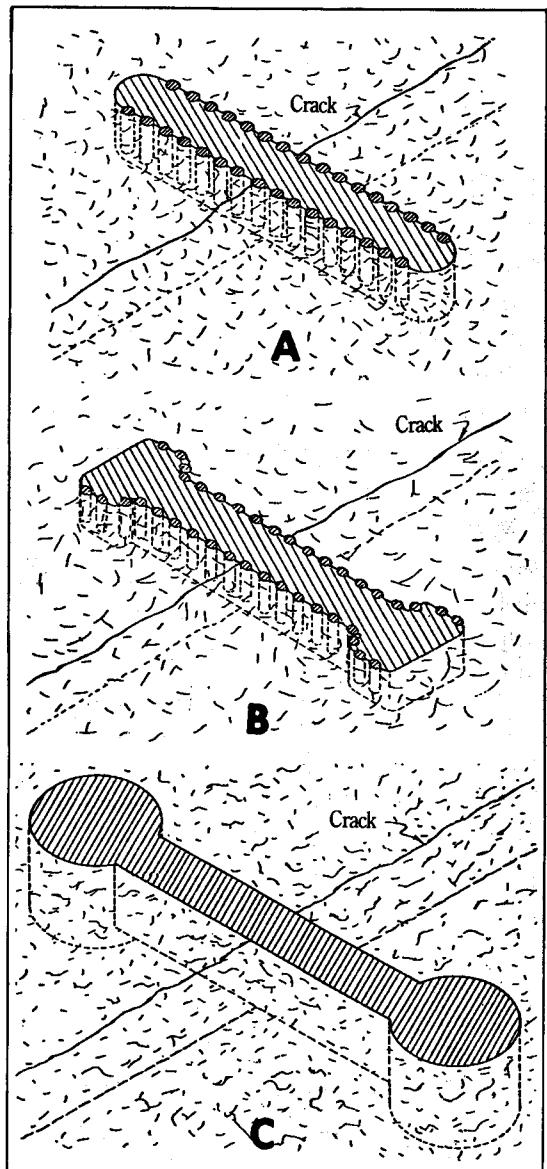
Masterlock 보수요소의 종류[16] : A) masterlock
